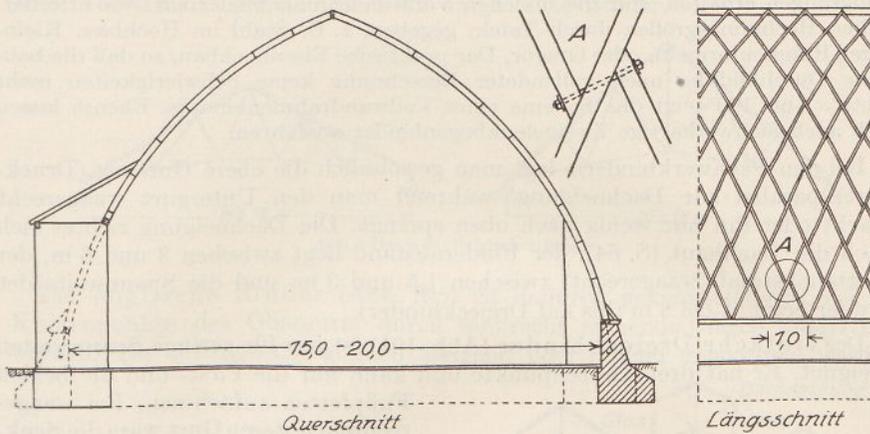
Zollbau-Lamellendach D. R. P. (Europäisches Zollbau-Syndikat, Hamburg.)
